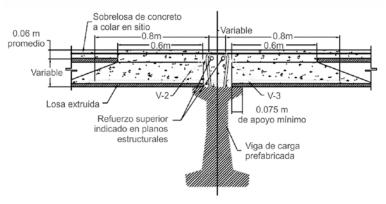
Detalles constructivos de Losa Lex (continuación)
